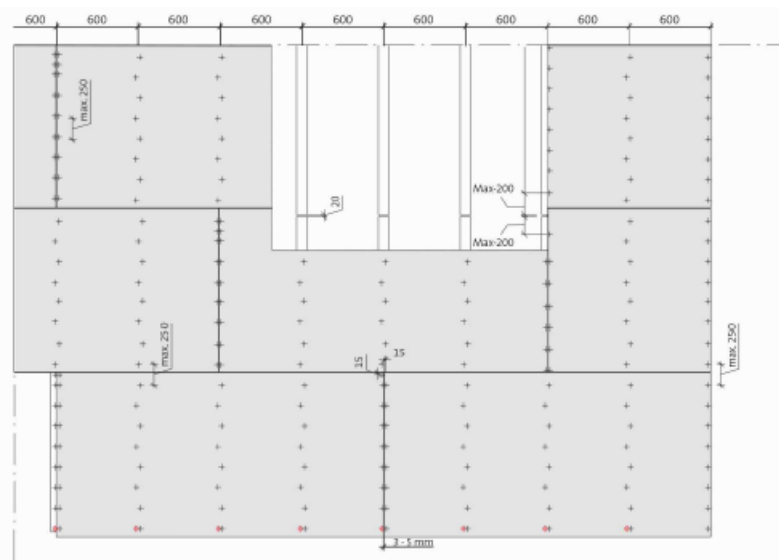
Detalhes técnicos de montagem das placas Glasroc X no sistema [78].
